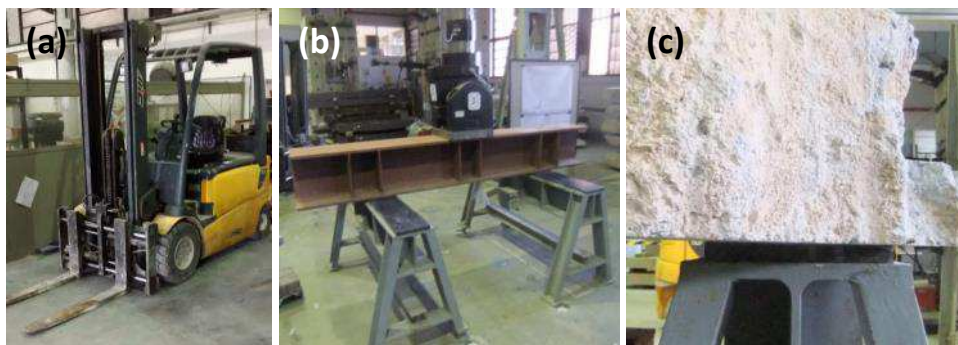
a) Carretilla elevadora, b) Viga de reparto y caballetes de apoyo, c) Neopreno
